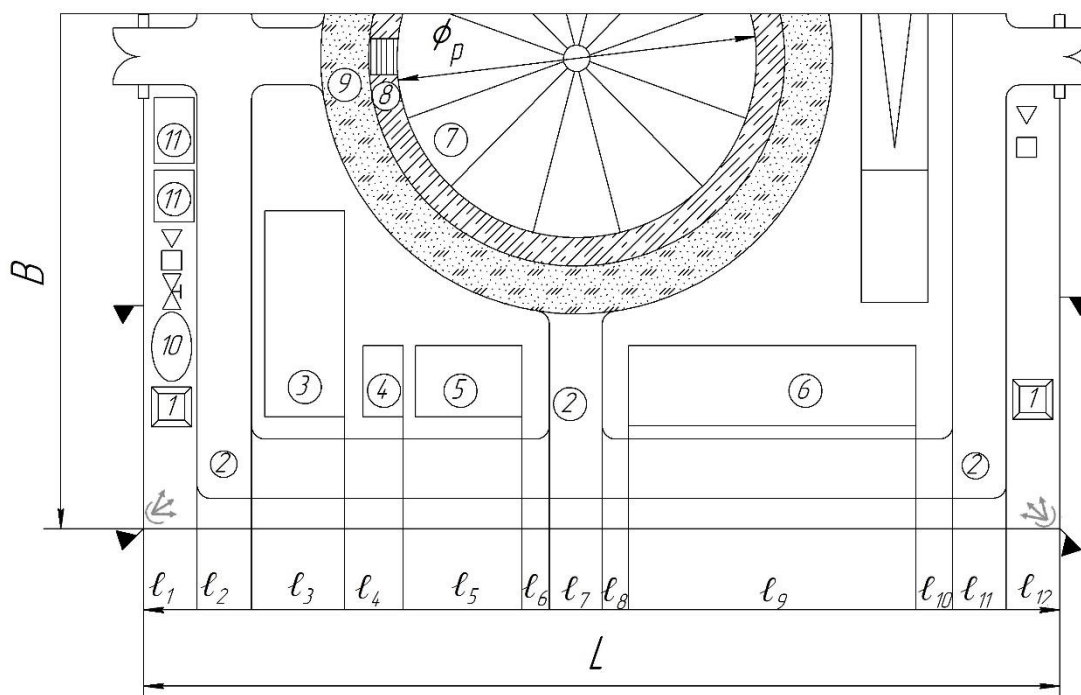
Схема планировки для расчета длины монтажной площадки:
